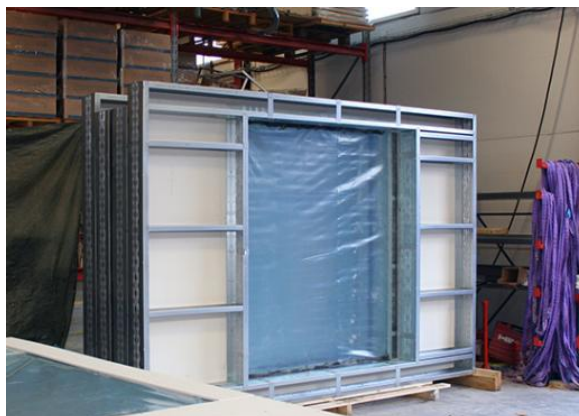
3D bild av ”bokhyllsystemet”, stomkonstruktion.[46]
